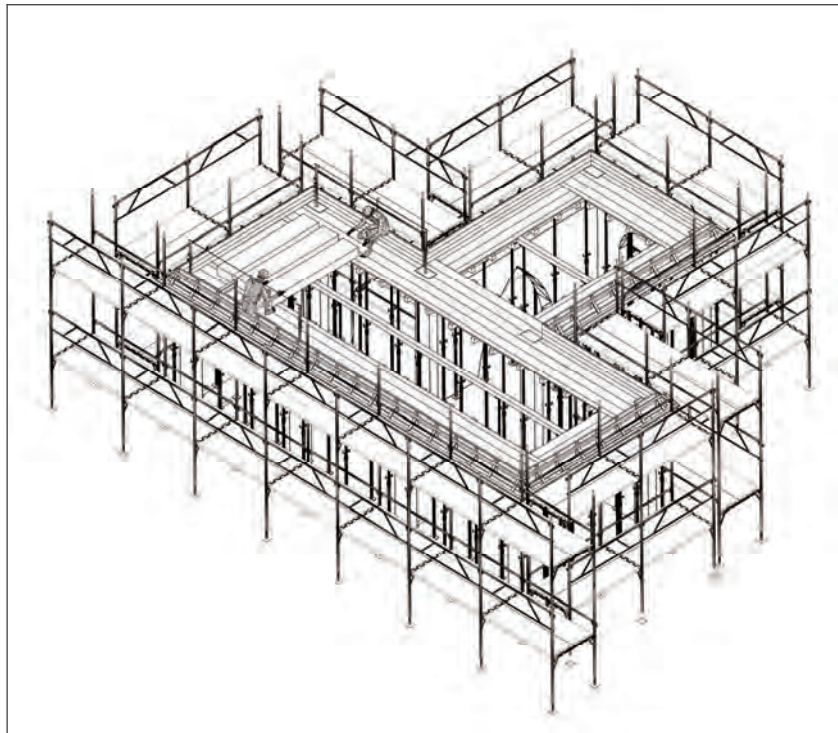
Vista assometrica della posa travetti e pignatte con D.P.I. anticaduta
